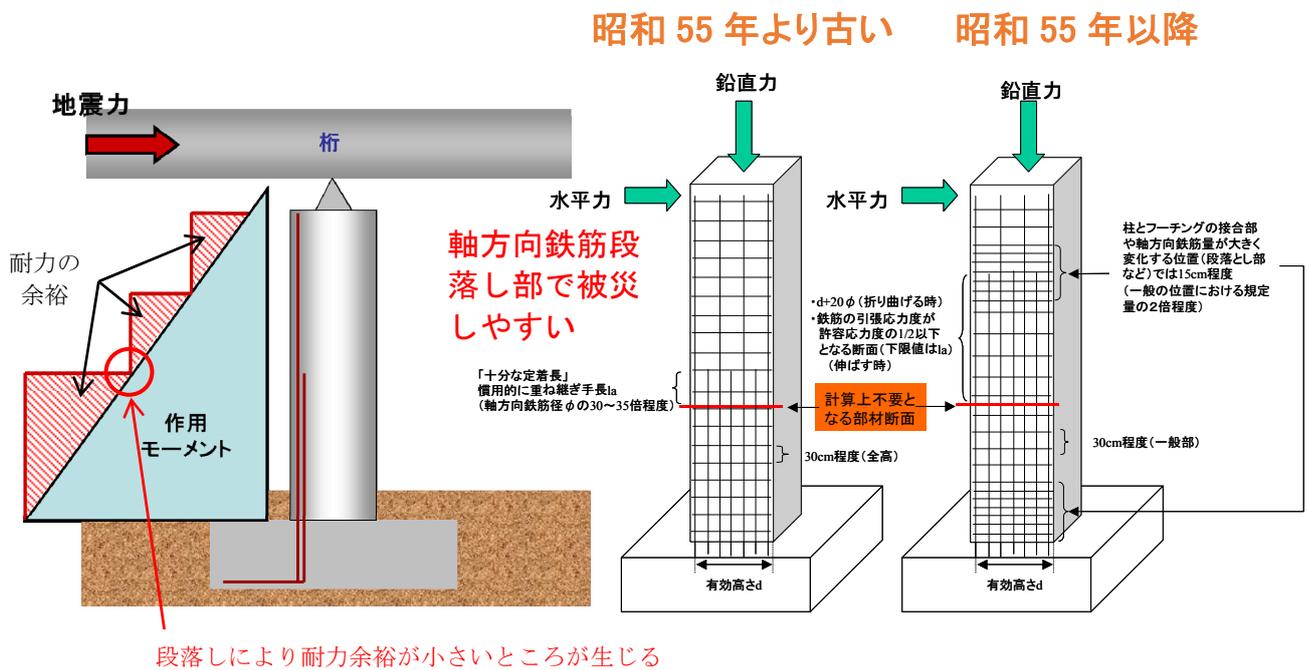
地震による鉄筋コンクリート橋脚段落し部の損傷
